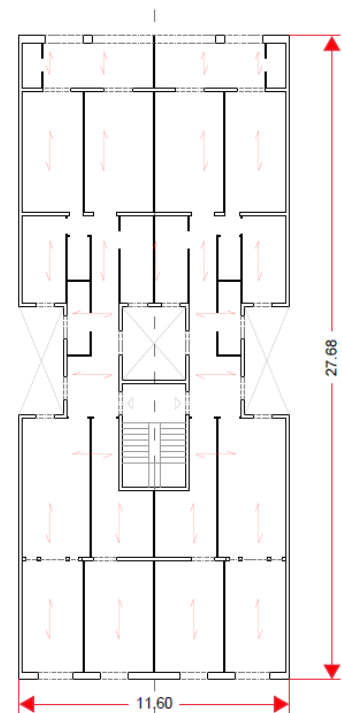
Plano estructural de la distribución en planta del edificio de la calle de Aragò 277 extraído de Cornadó (2015)
